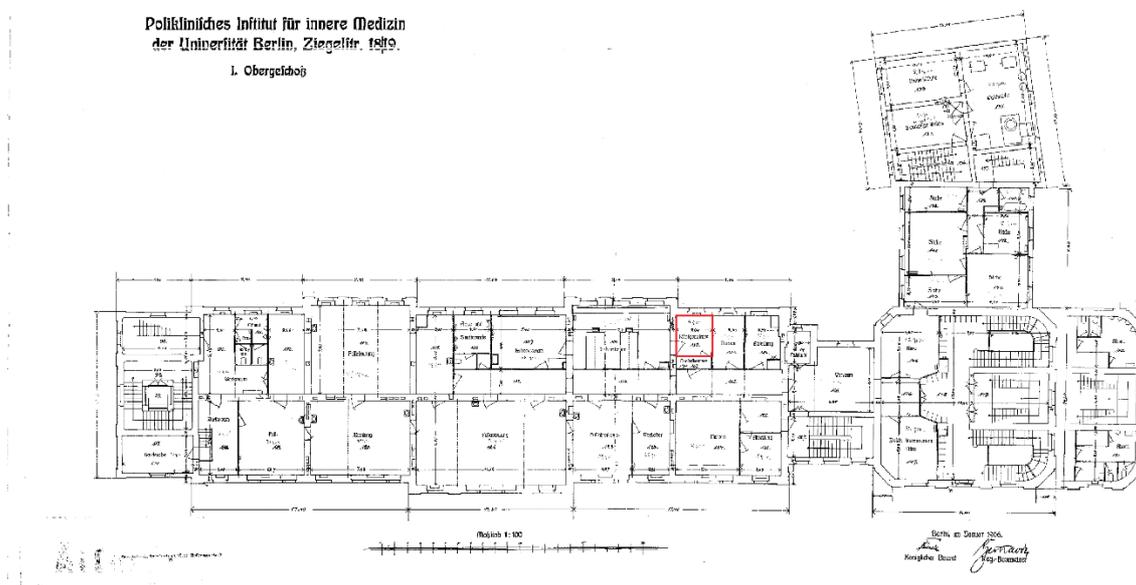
Lageplan des Gebäudes in der Ziegelstraße 18/19³
